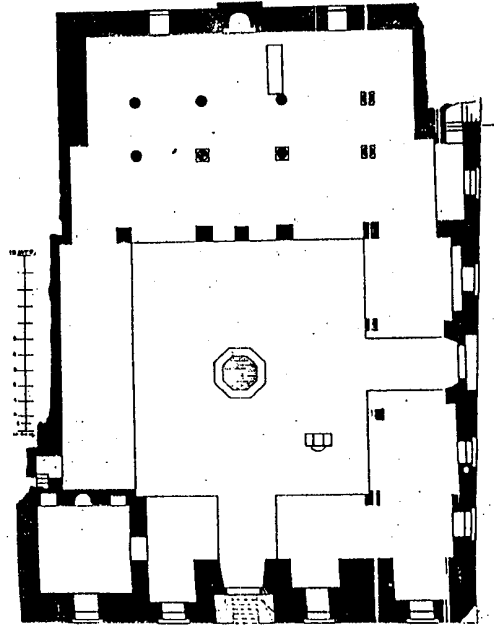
مسقط أفقي لجامع القاضي يحيى زين الدين ببولاق بالقاهرة
